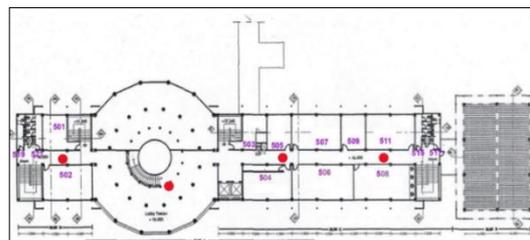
Denah Lantai 3 Gedung FTI UKSW
